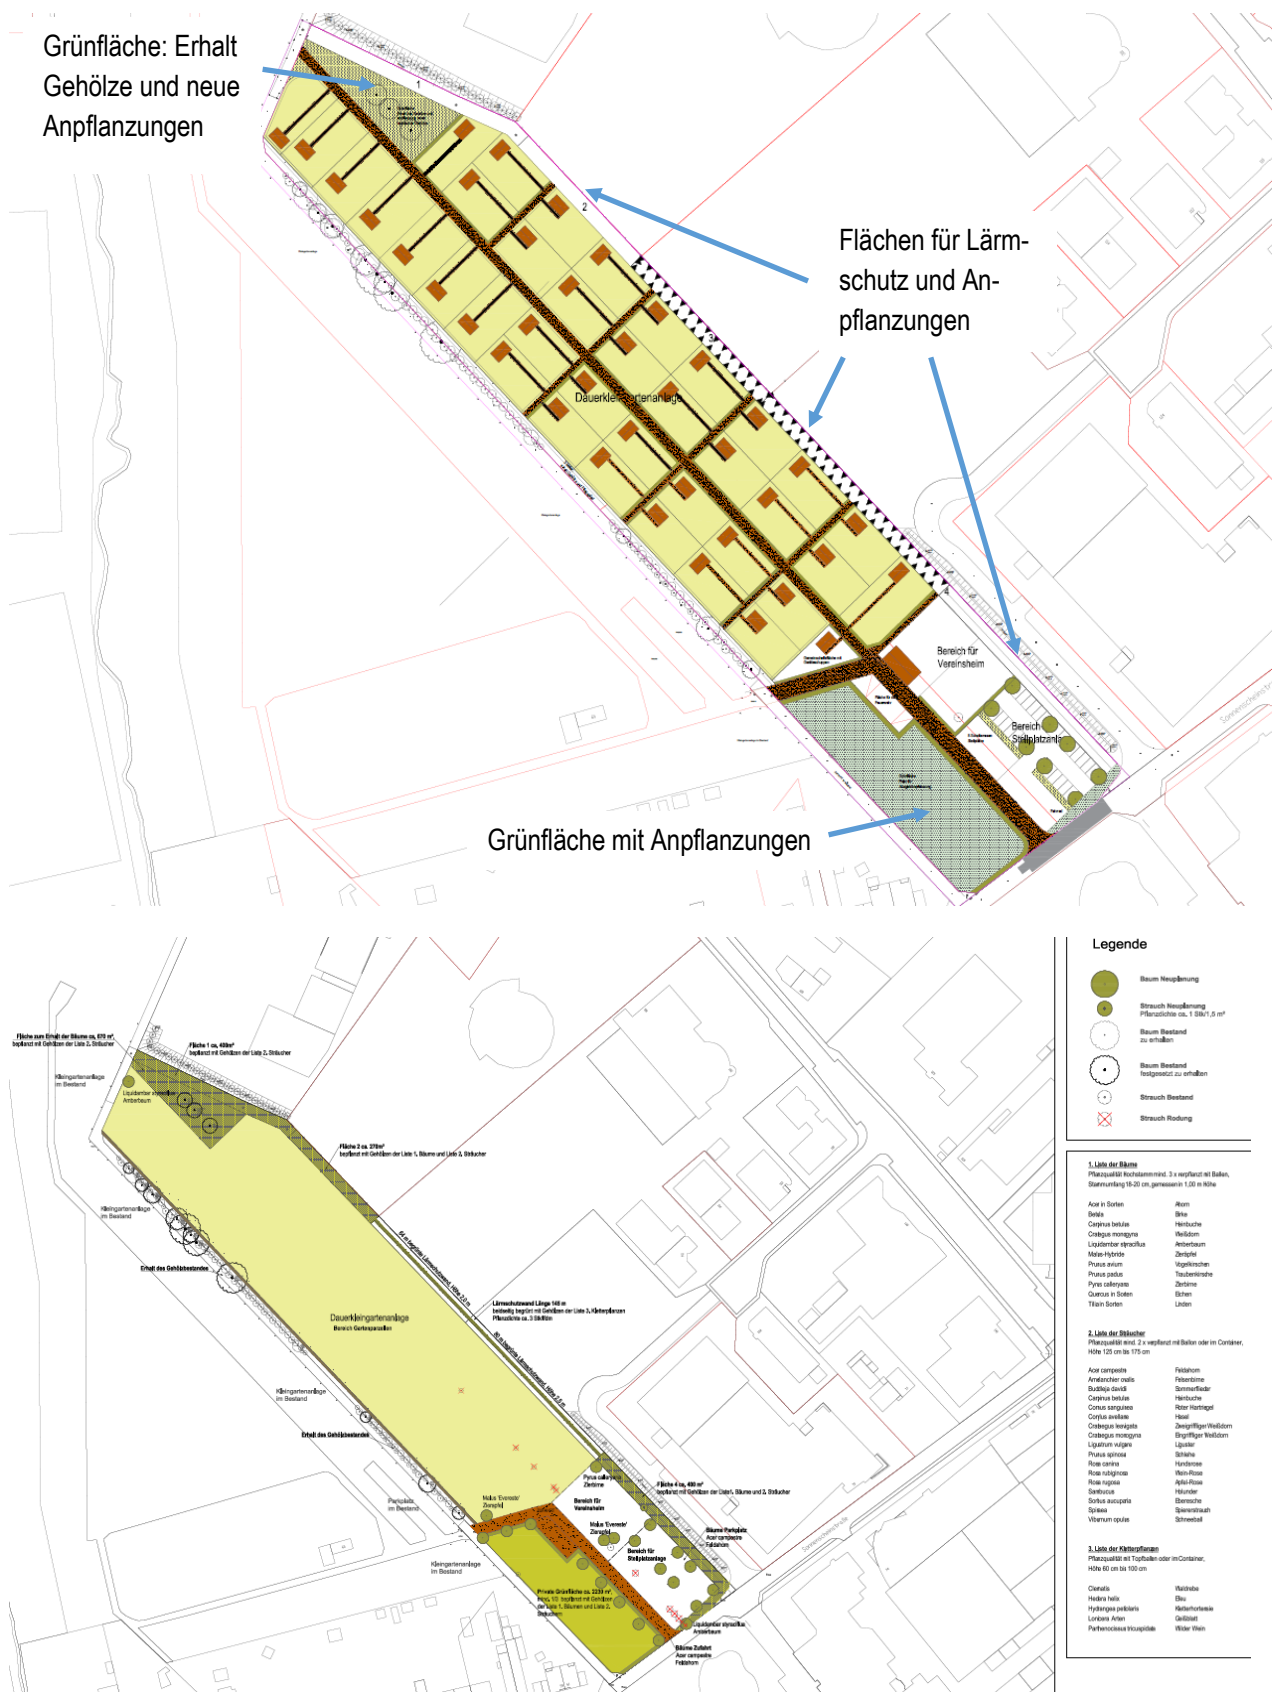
Planungskonzept für die Kleingartenanlage (oben) sowie Grün- und Freiflächenplan (unten)
